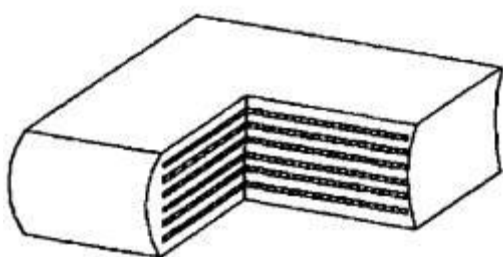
Вид недопустимых общих искривлений боковых поверхностей резиновой опорной части под нагрузкой
